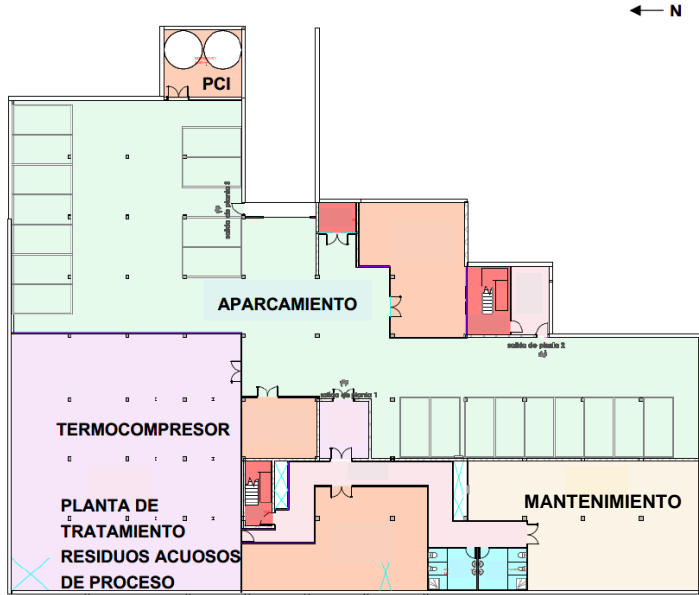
Implantación en la planta farmacéutica en planta sótano según la alternativa B.2.1.1.a
